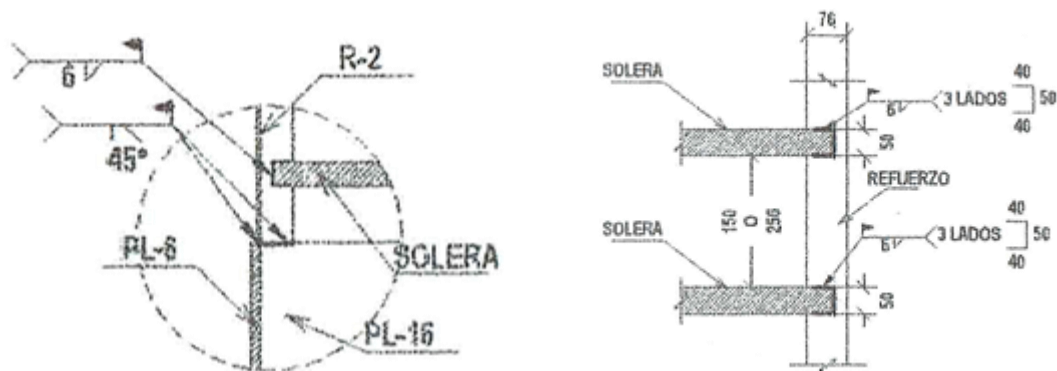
Detalles de la aplicación de soldadura al sistema de refuerzo del Edificio G de la UAM-Azcapotzalco, tomado de los planos estructurales de Gómez González (2020).
